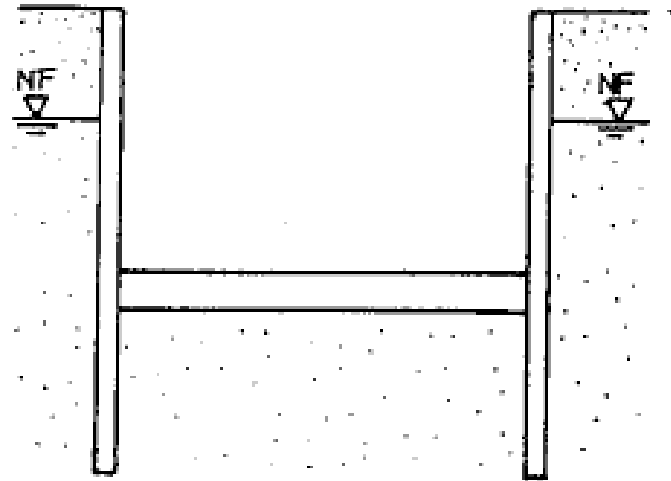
Solución recomendada de muro pantalla y losa de cimentación.
